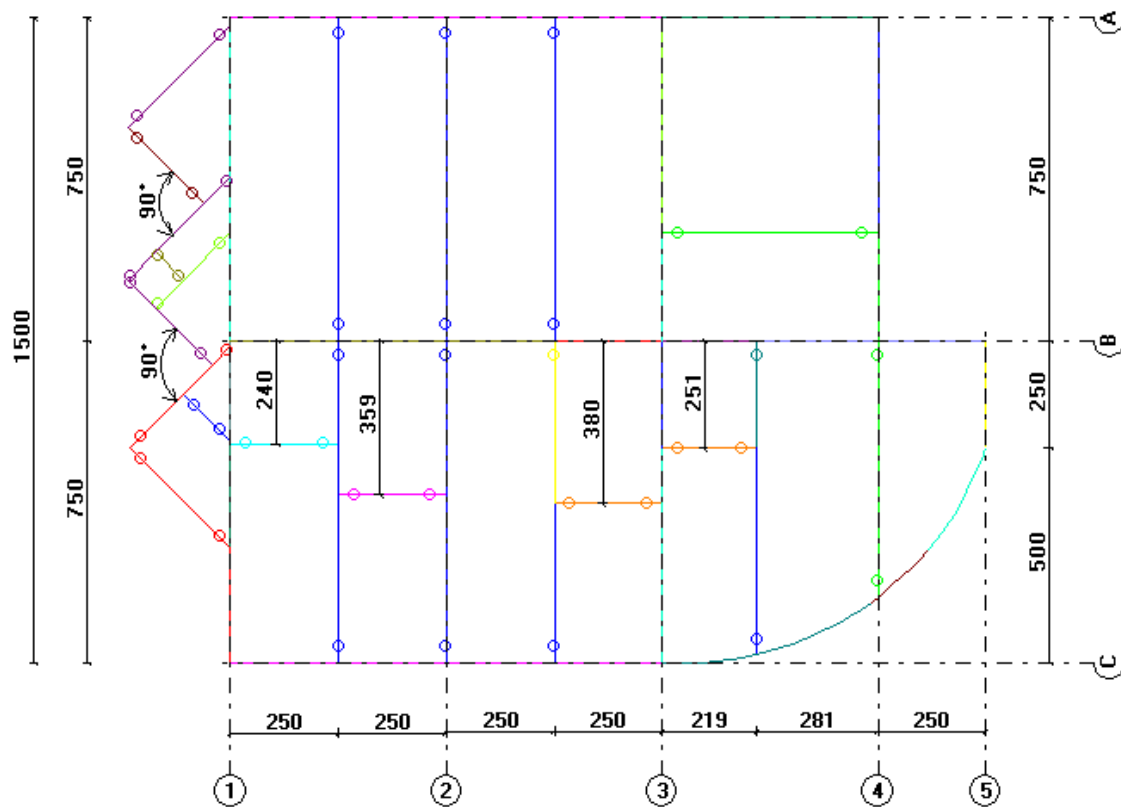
Modelo Estrutural – Planta 2º Pavimento – Dimensões em cm
